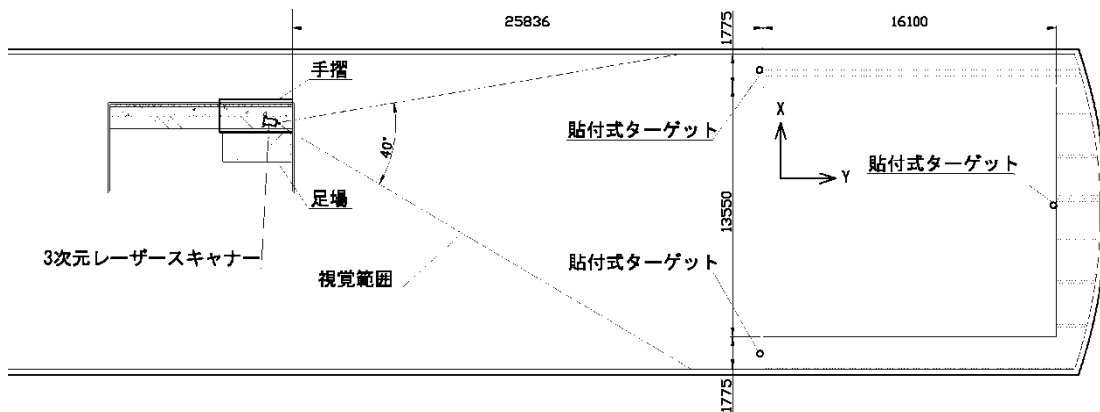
3D レーザースキャナーの計測配置（平面図） [3]
